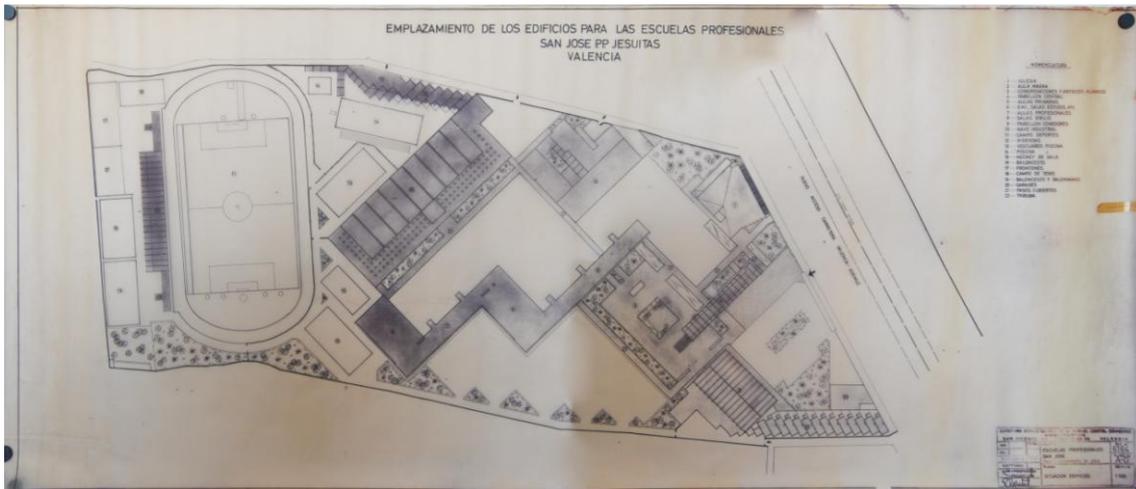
Plano de la propuesta definitiva Escuelas San José. *Archivo Escuelas San José.
